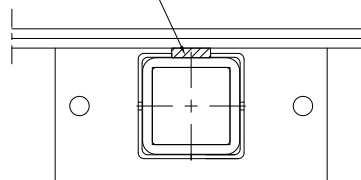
fixation de la plinthe de butée avec montant à travers une platine de 5mm d'épaisseur pour faciliter l'escamotage du garde-corps
